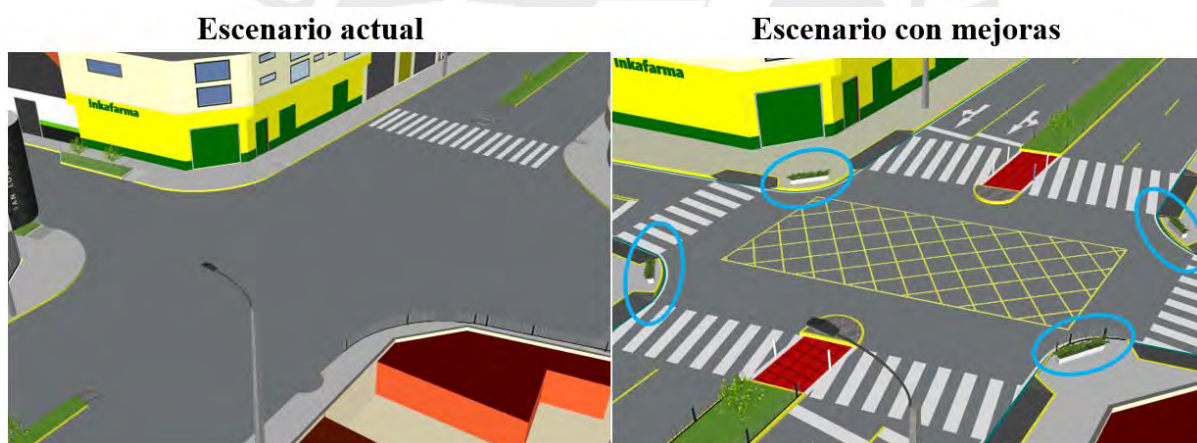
Plantas bajas para bloquear cruce en diagonal.
